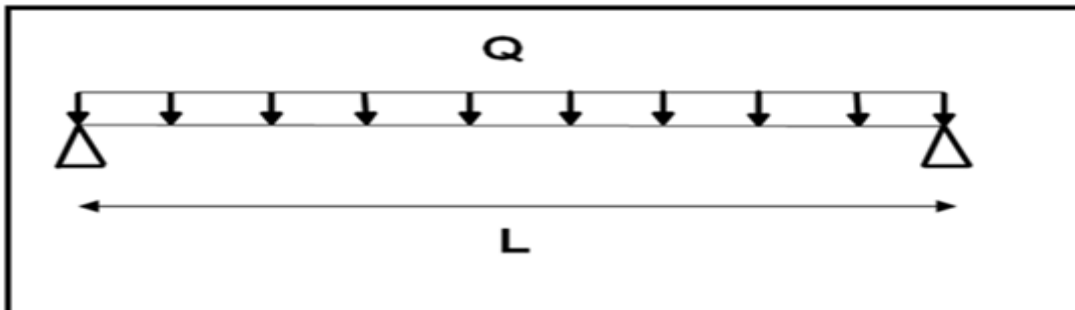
Schéma statique de la poutre de roulement sur deux appuis
